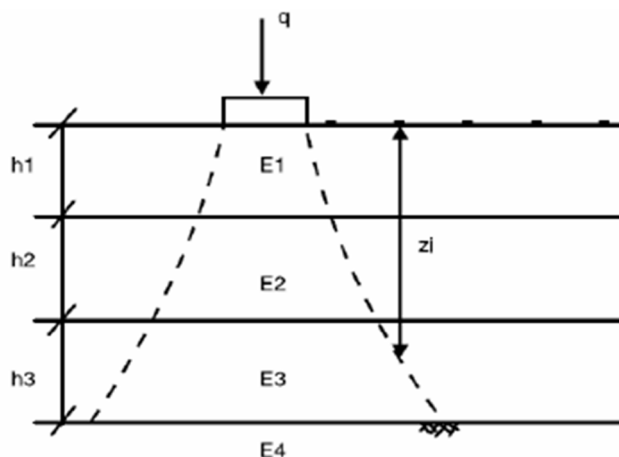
Modelo para a determinação de parâmetros do pavimento a partir de ensaios de FWD
